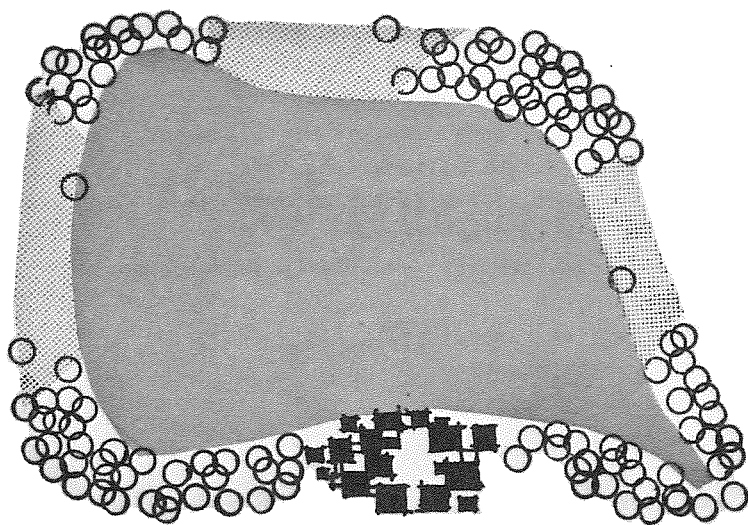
Liian korkea ja viimeistelemätön täytetty ranta on asukkaiden kannalta käyttökeltoton ja pilaa näkymät vesiltä rannalle päin.
